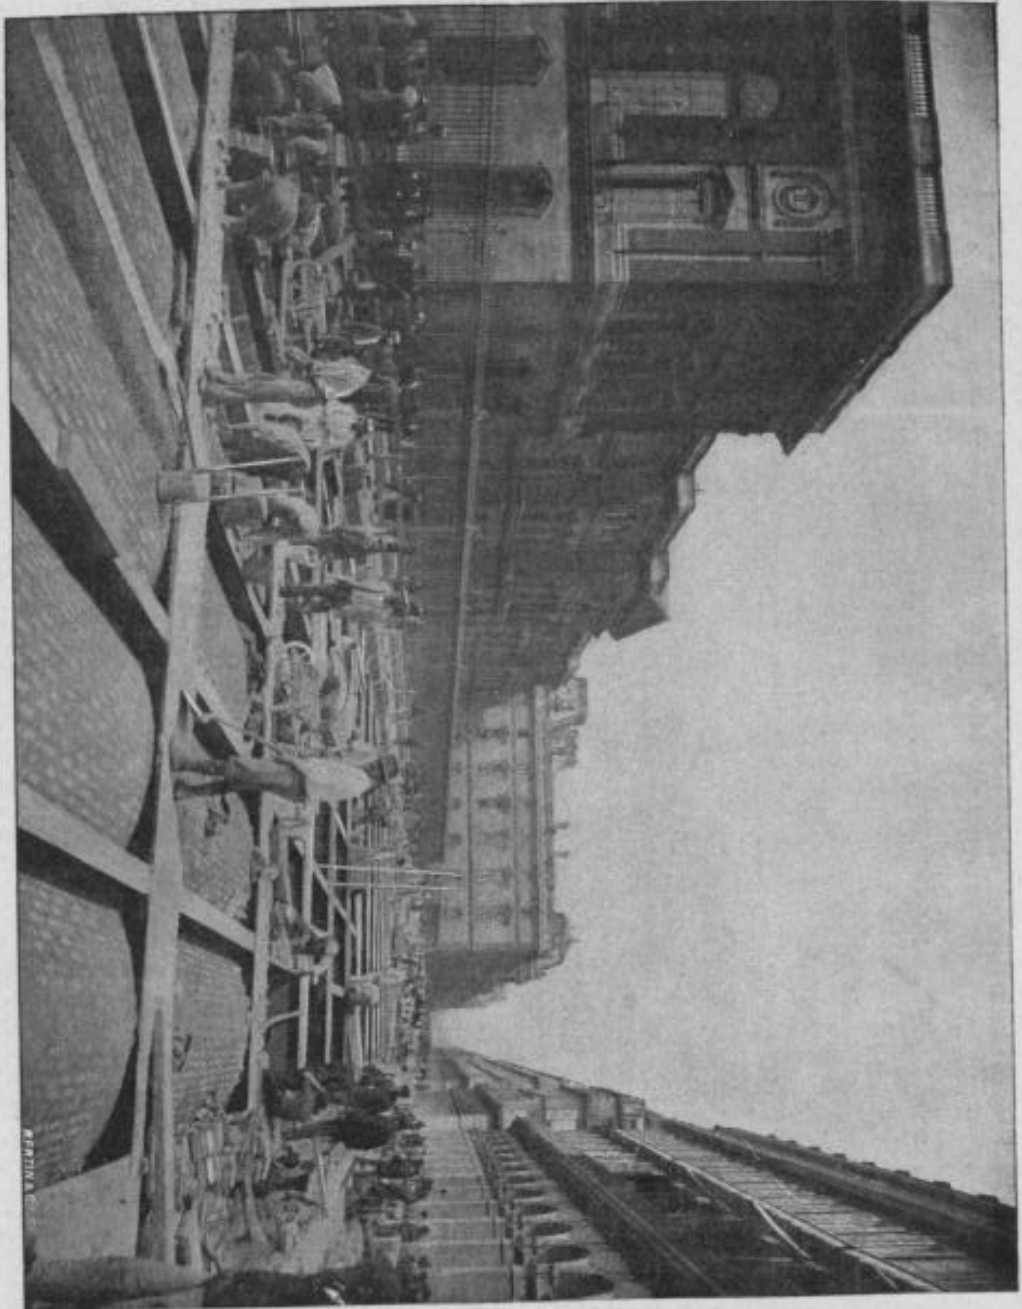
Construction du plancher métallique de la station du Louvre; vue prise le 1^{er} juin 1899.
